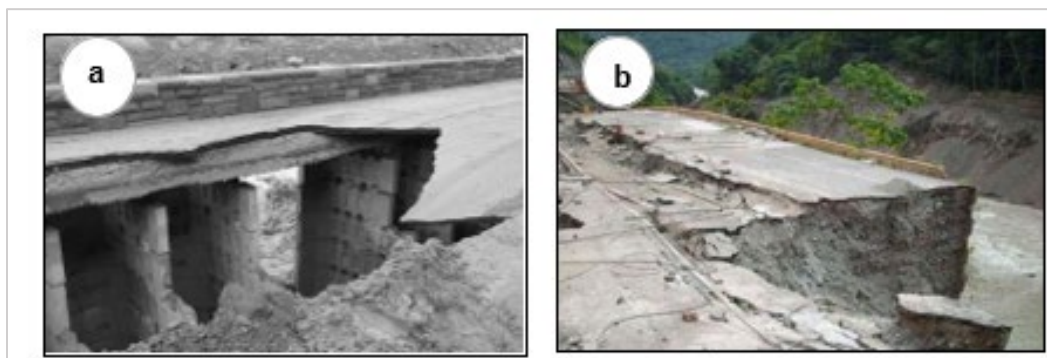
Fallas de muros por socavación: a) Socavación del muro que afectó la carretera sobre el río Virgin, EE.UU. b) Socavación del muro con afectación de una autopista en Mérida, Venezuela
